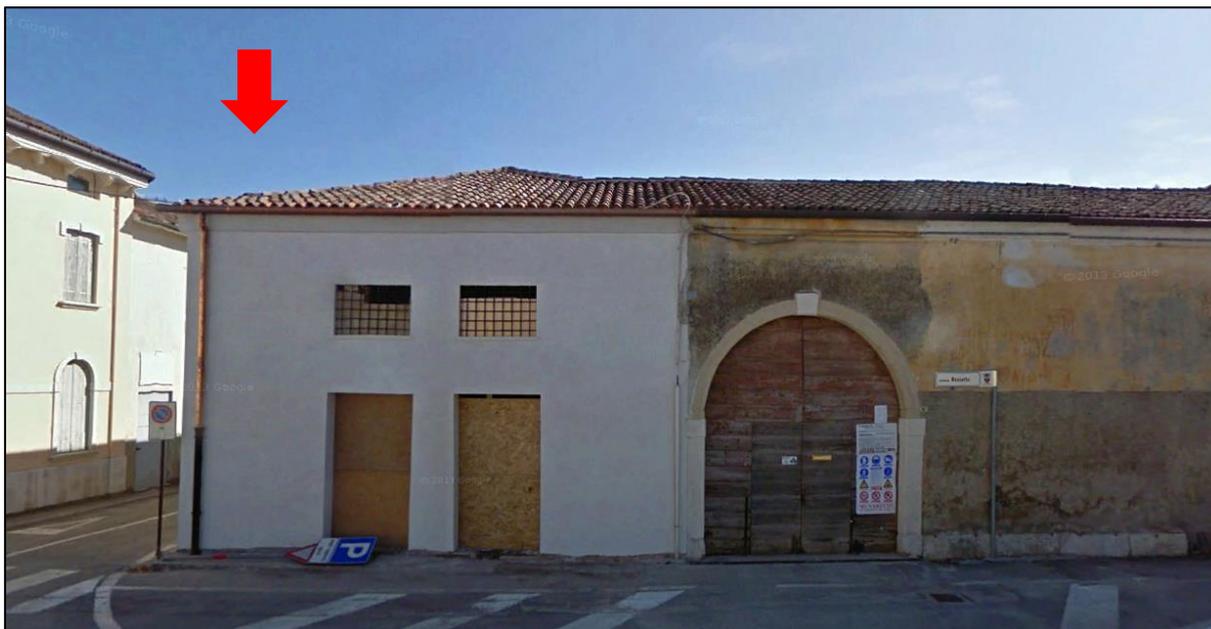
Barchesse di Villa Checozzi - Dalle Rive viste dalla piazza di San Tomio. L'intervento è localizzato dalla freccia rossa, e come si nota non è visibile
